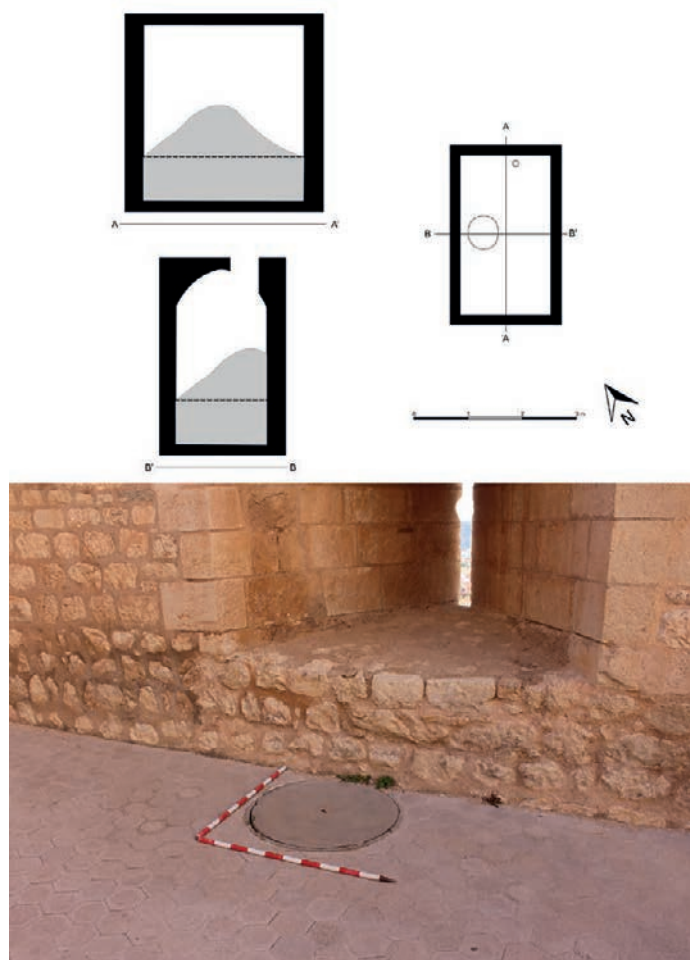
Vista exterior de la boca del aljibe II y la planta y las secciones del mismo (Archivo Museo Dámaso Navarro).
